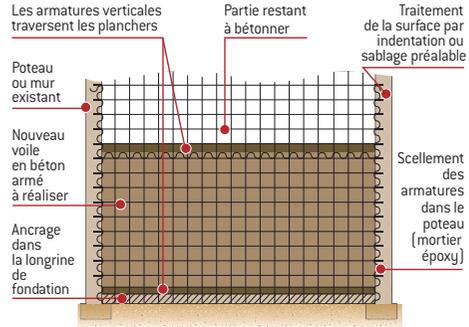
Exemple de renforcement du contreventement d'un bâtiment par création de murs nouveaux entre deux poteaux existants (élévation)
